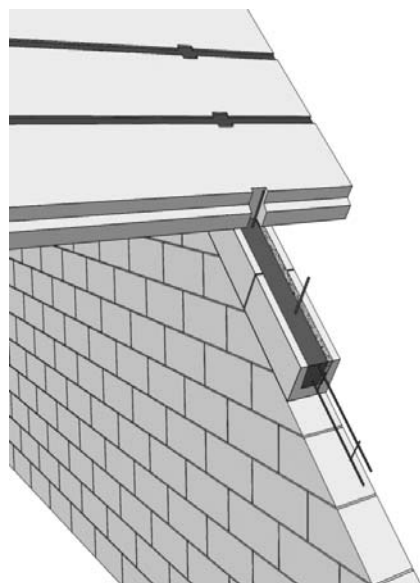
Опираение элементов скатной кровли на наружные стены
